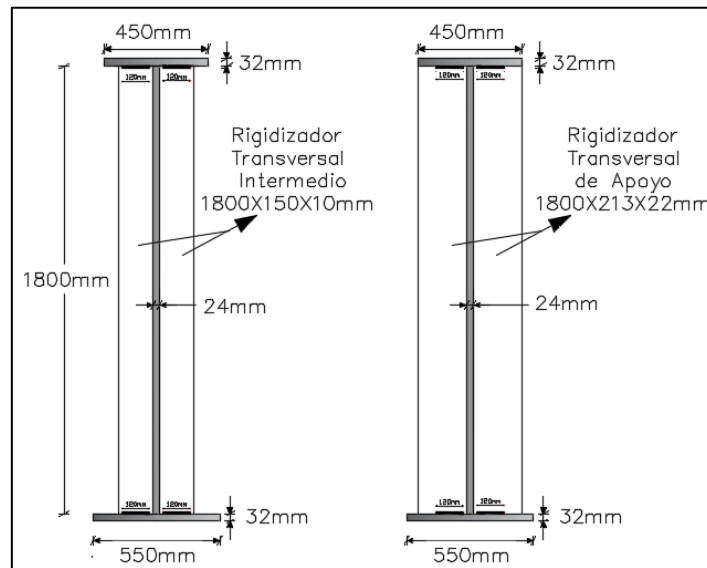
Soldadura de filete entre el rigidizador transversal y el patín inferior y superior.
